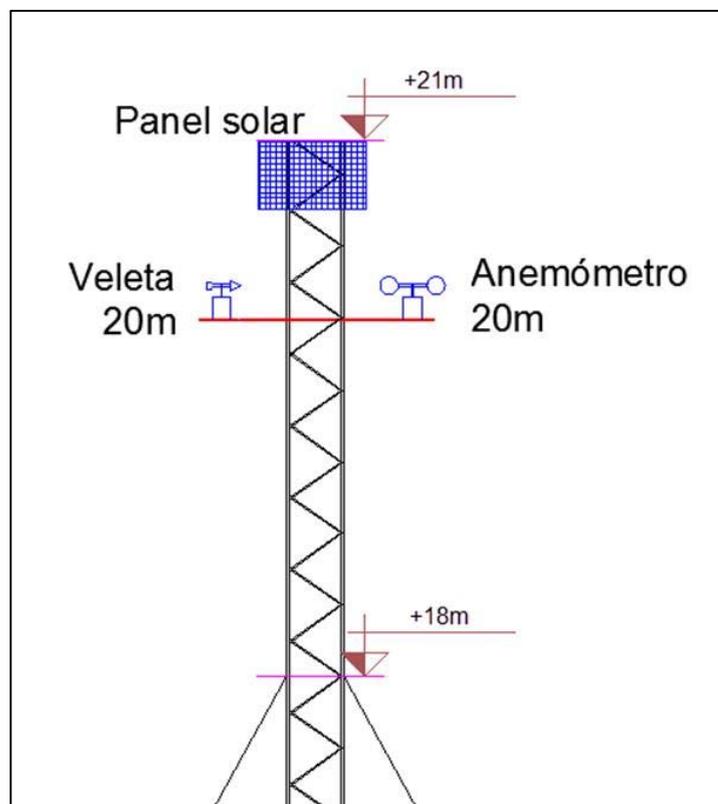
Croquis Ubicación de Equipamiento a 20 m sobre la antena.
